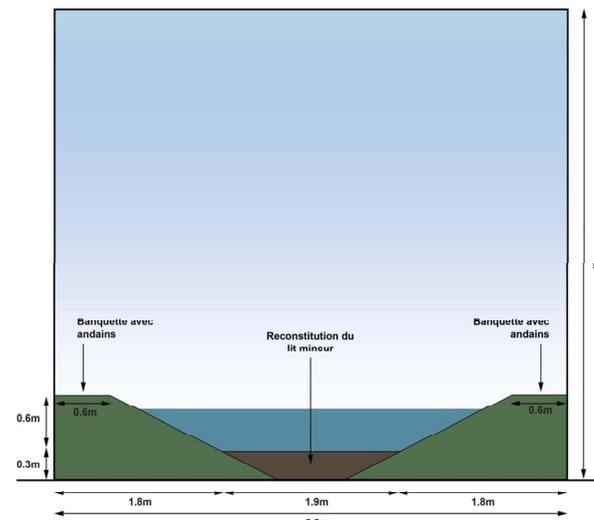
PLAN DE PRINCIPE DE L'OUVRAGE MIXTE OH11 (OUVRAGE HYDRAULIQUE ET PASSAGE FAUNE)
